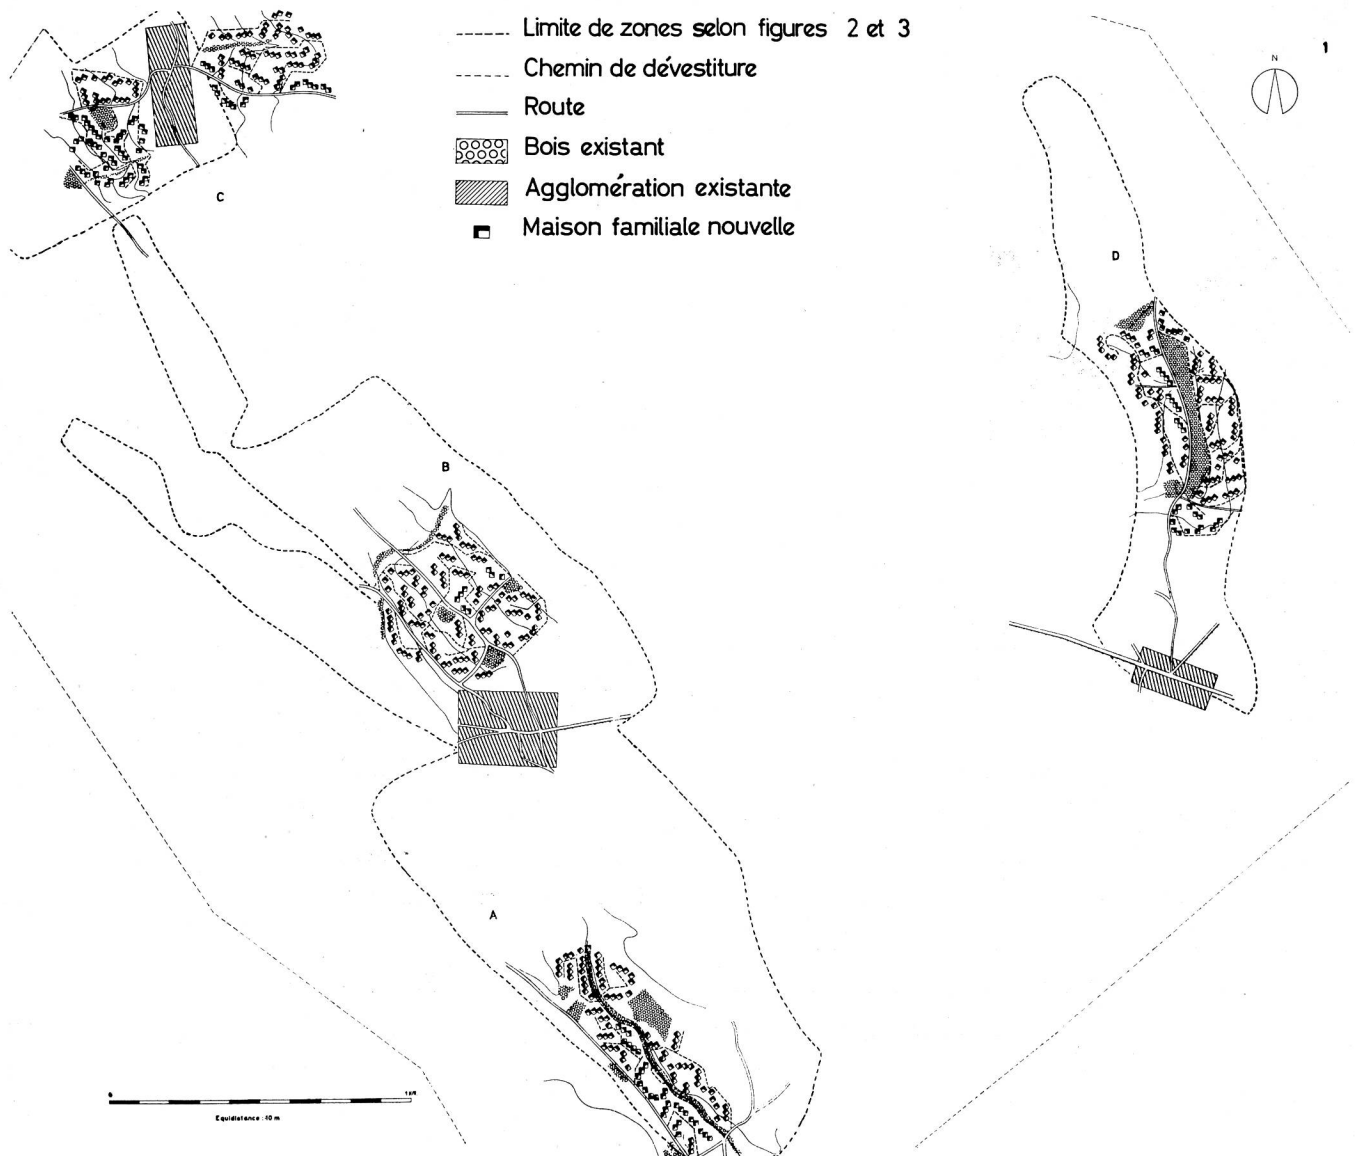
Zones de construction souhaitable avec implantation de villas.
